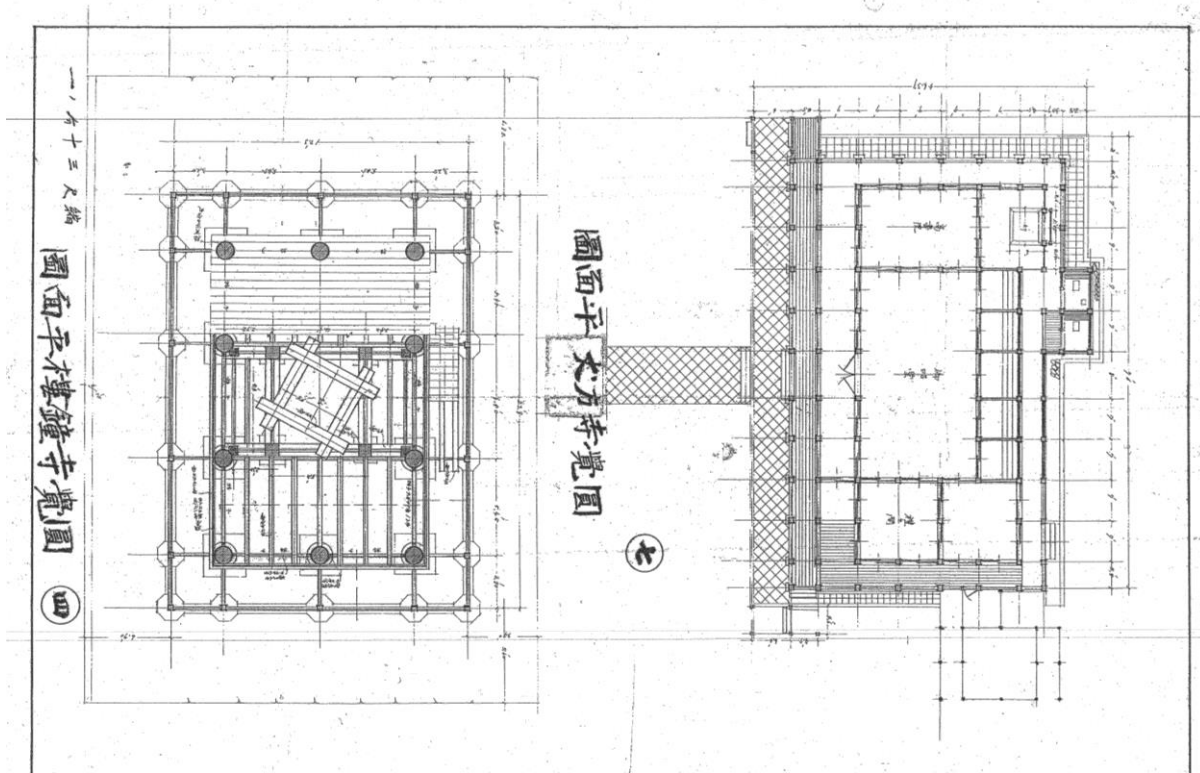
四 圓覺寺鐘樓平面圖 七 圓覺寺方丈平面圖
